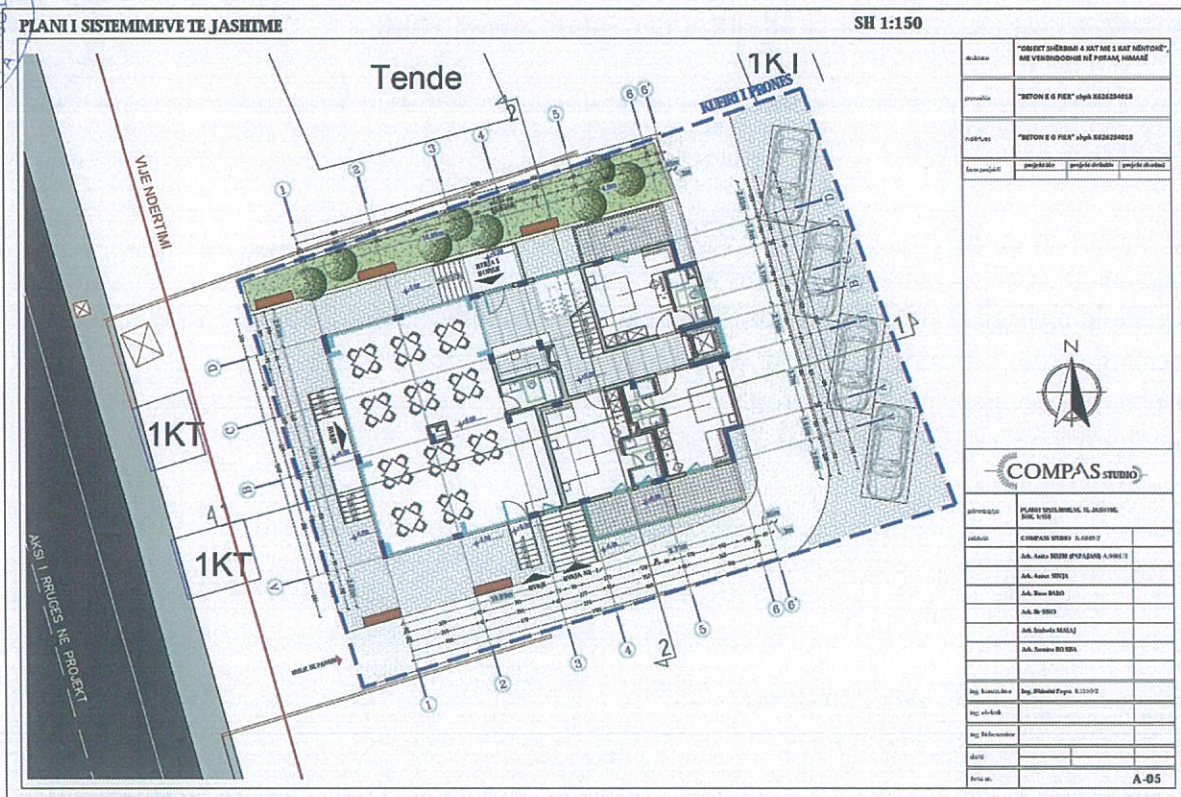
Plani i hapësirave të jashtme të objektit të propozuar
